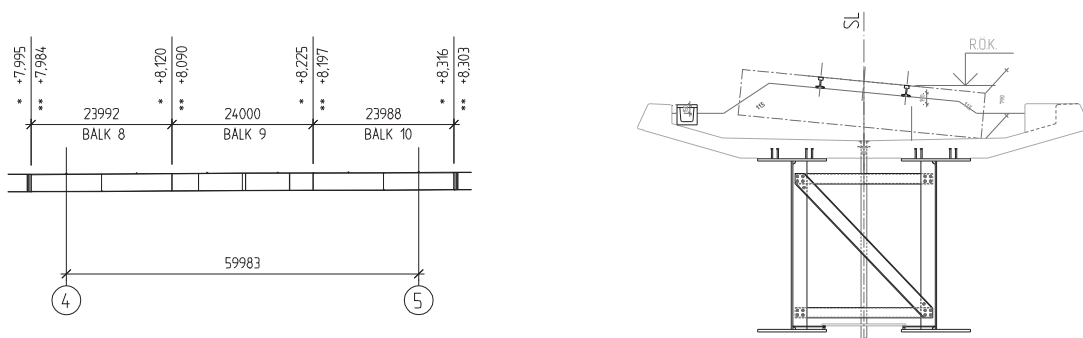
Elévation et section transversale du pont sur le Veckefjärden.
